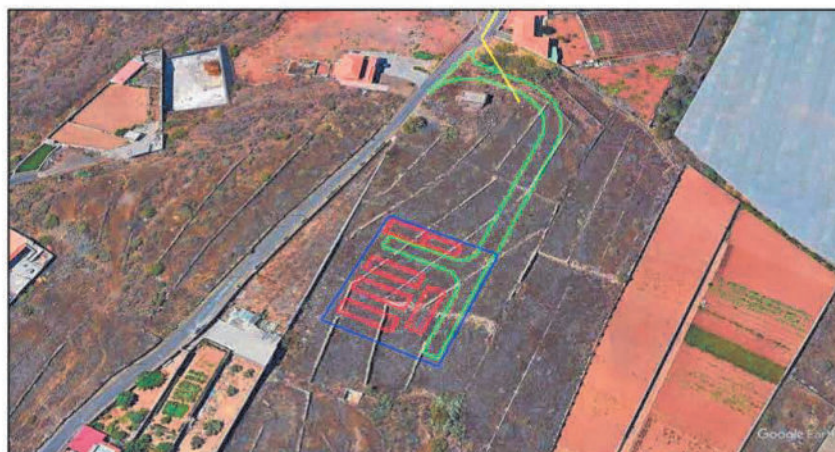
Planta y acceso "SAEB GÜÍMAR"
